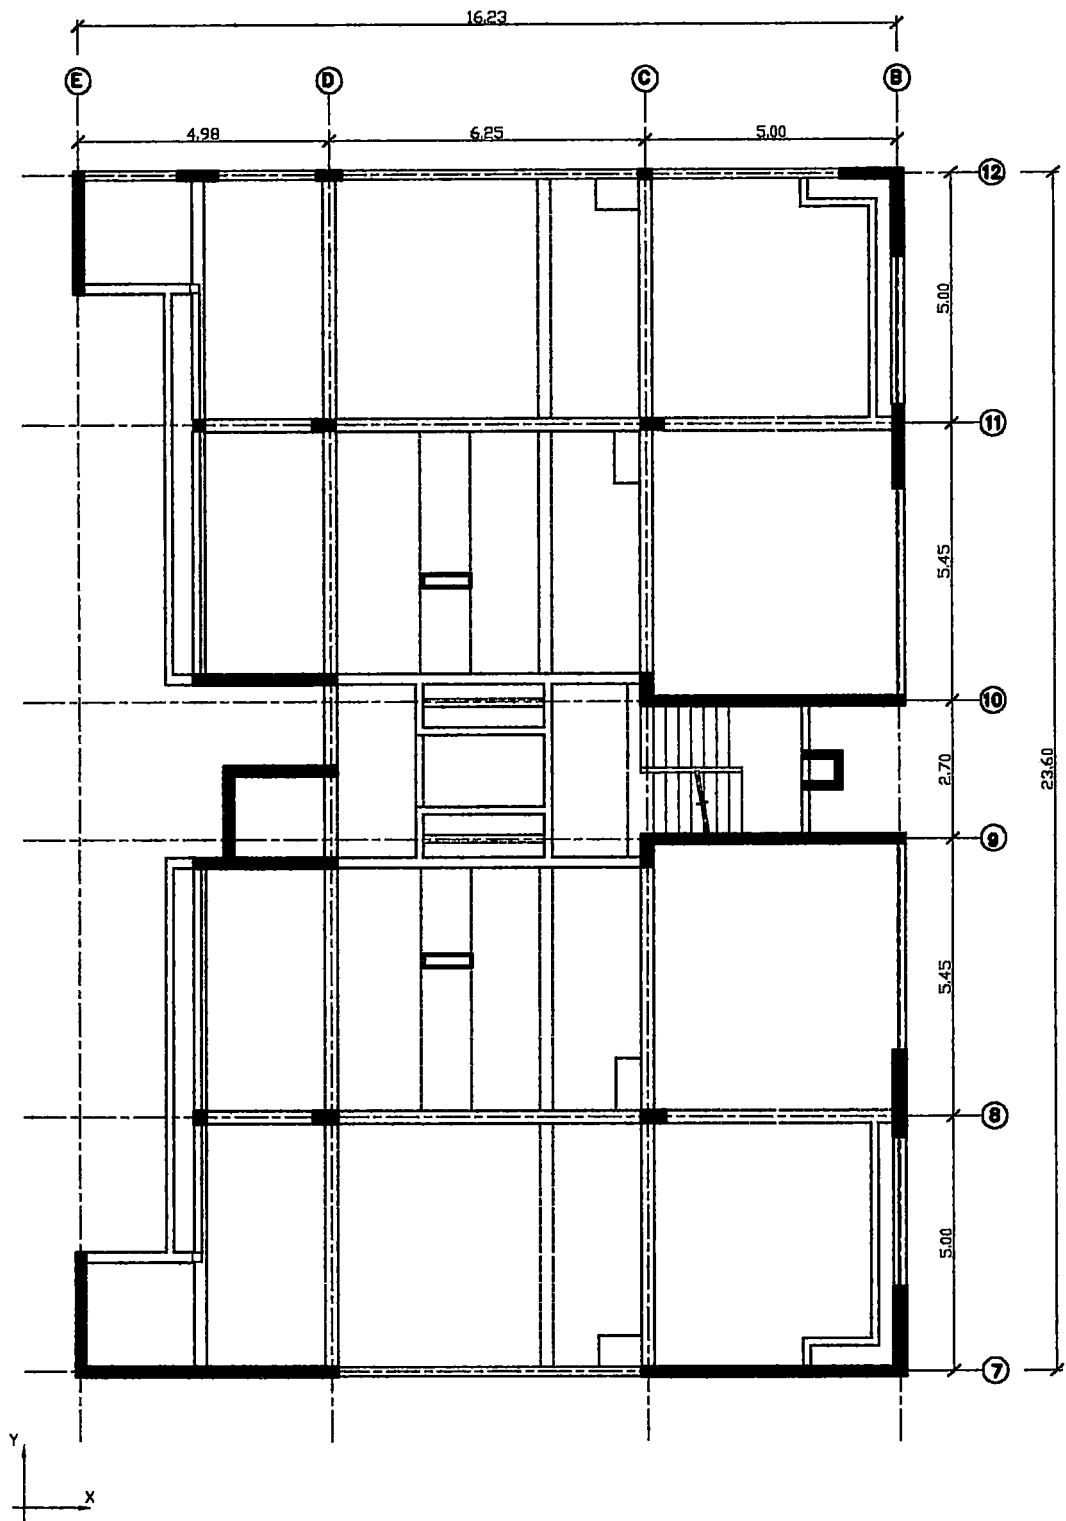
MÓDULO II - PLANTA TÍPICA 1
